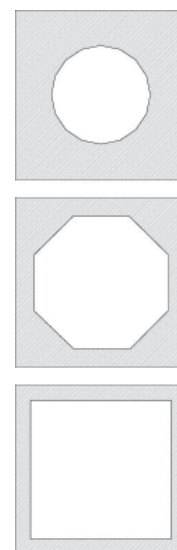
Secciones horizontales de la Sala de Dos Hermanas. Sección cuadrada en planta baja, sección octogonal en planta primera, y sección circular en la cúpula. Dibujo del autor.
